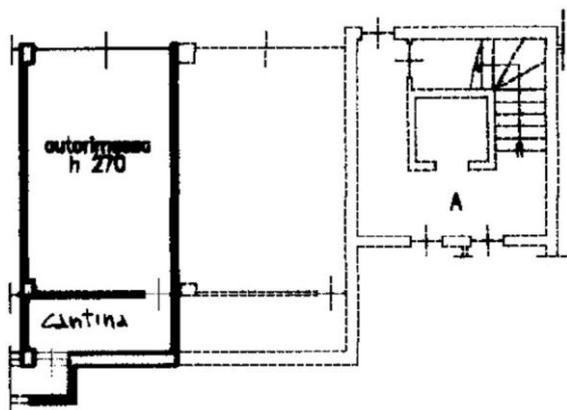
planimetria catastale autorimessa particella 2357 sub 25
